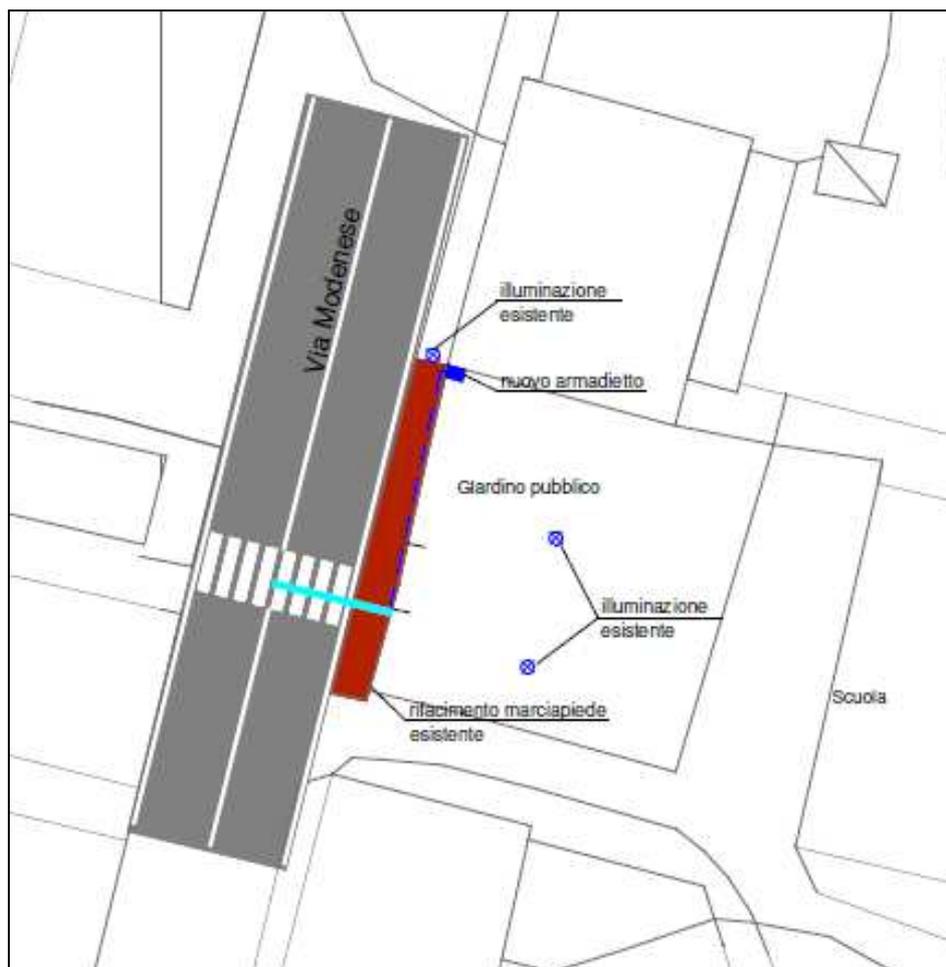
Stato di Progetto Via Modenese – Loc. Le Piastre - Planimetria
